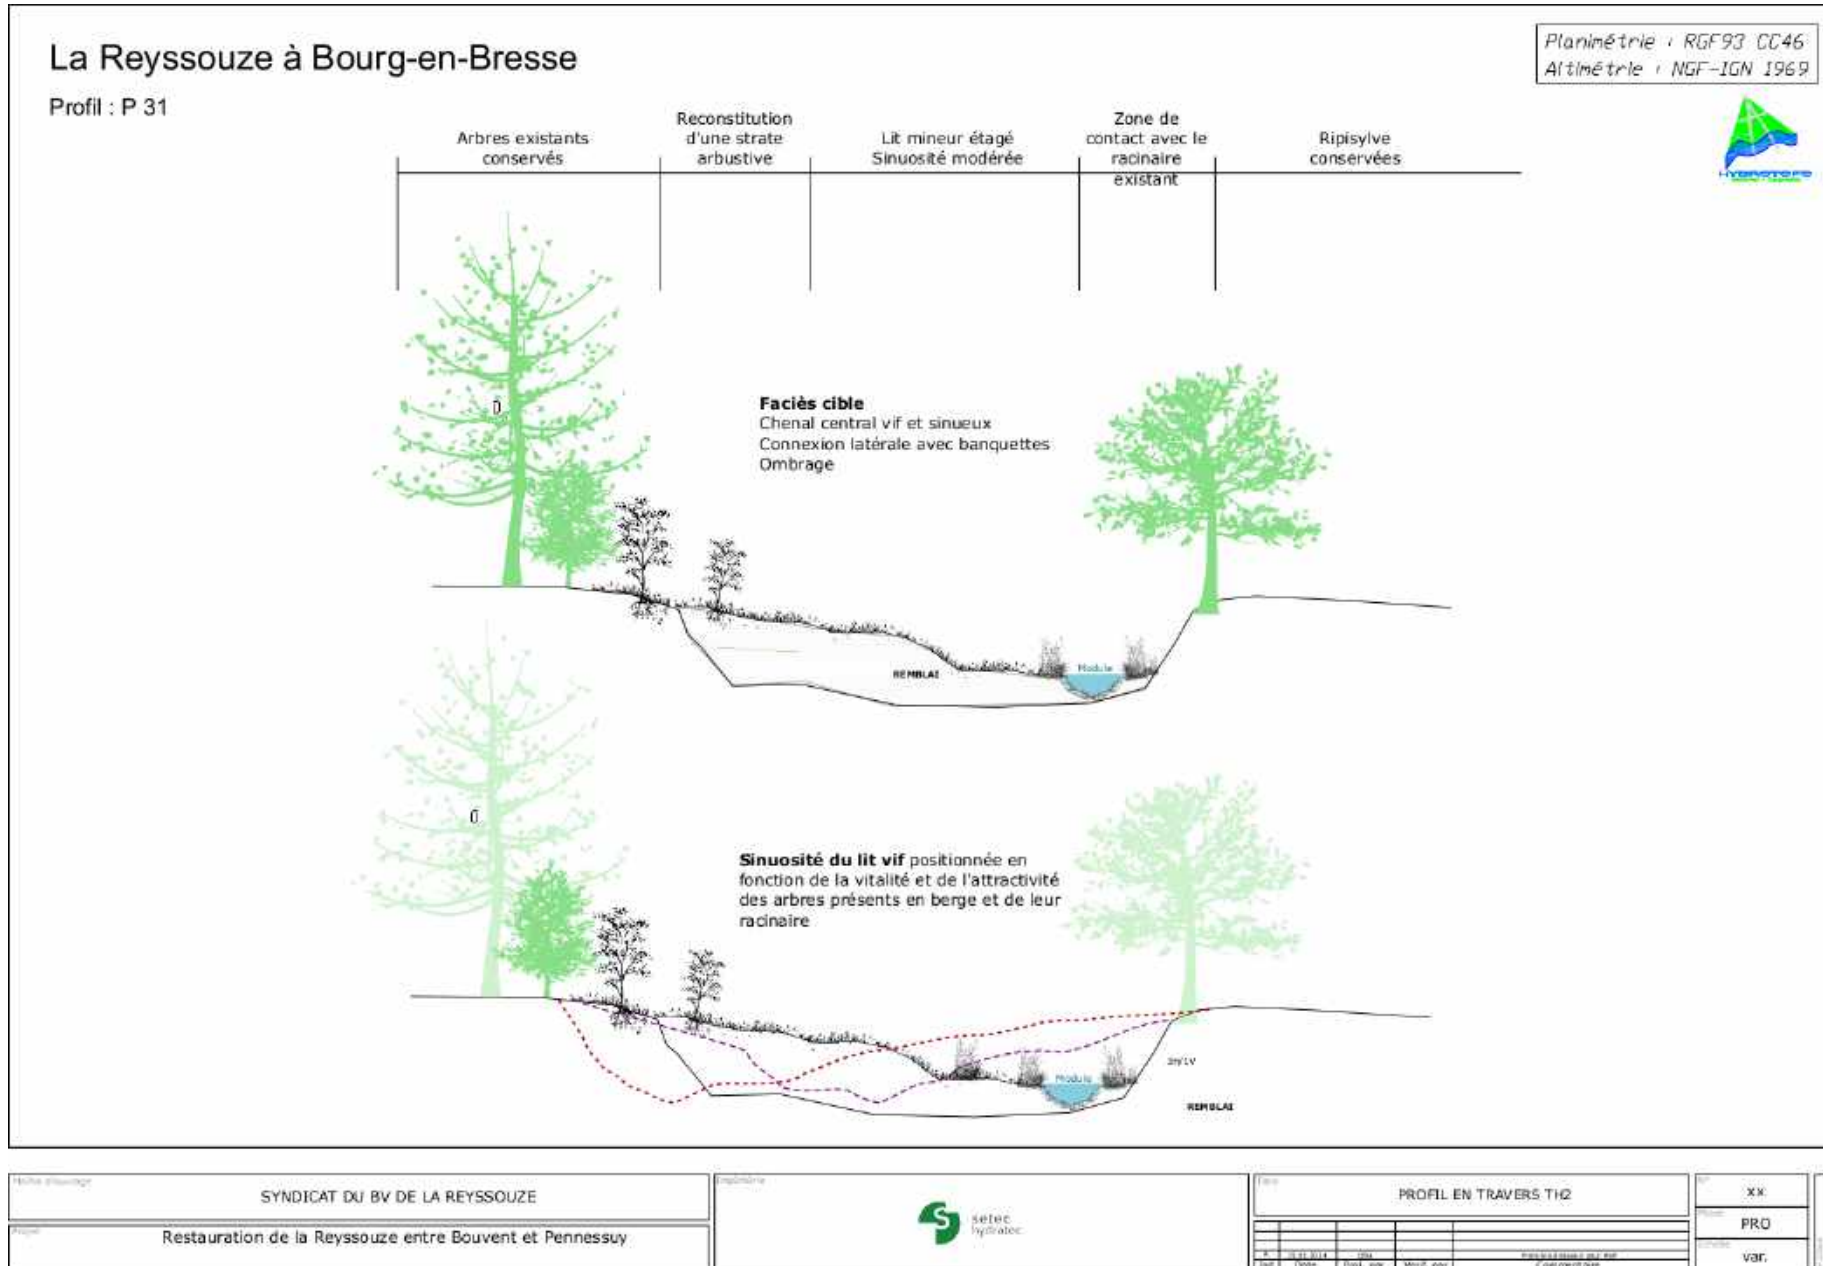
Profil en travers sur le tronçon 2 (SETEC/HYDRATEC)
